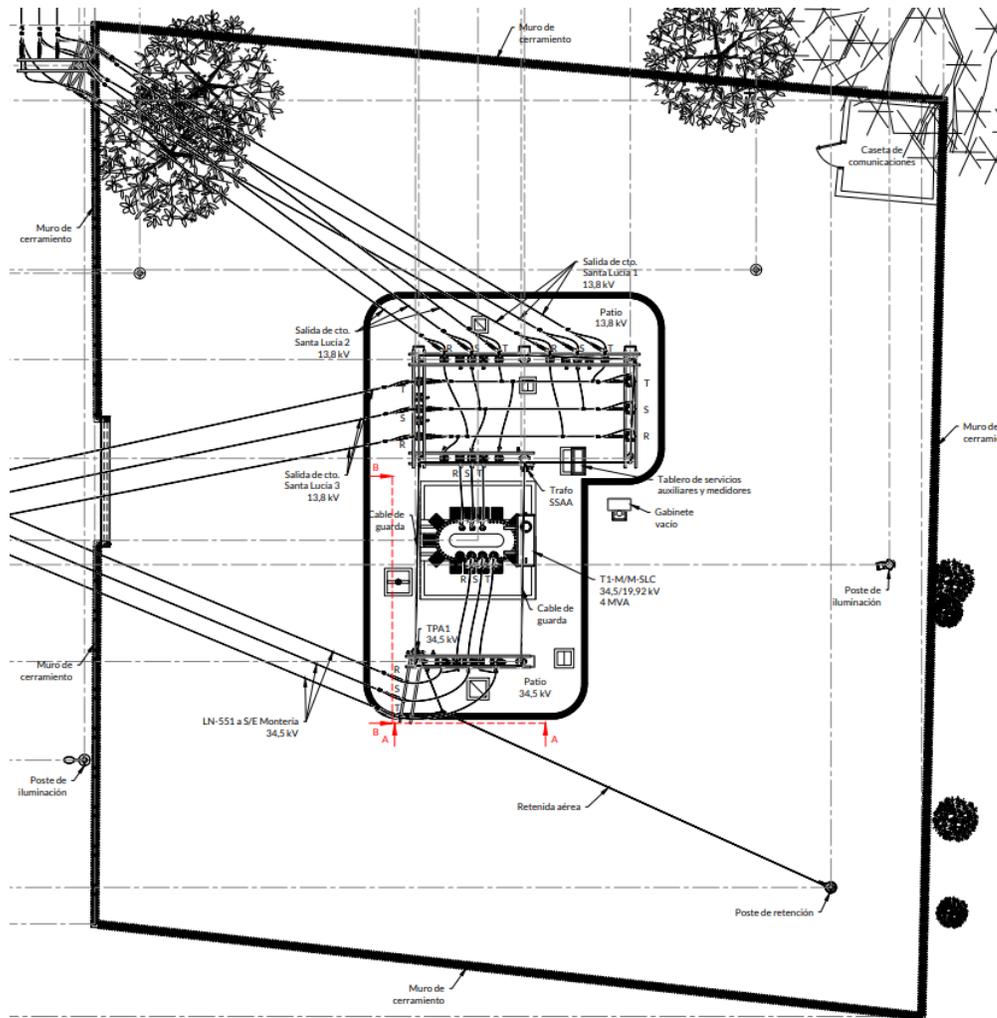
Disposición en planta de la SE Santa Lucía anterior a la intervención.
